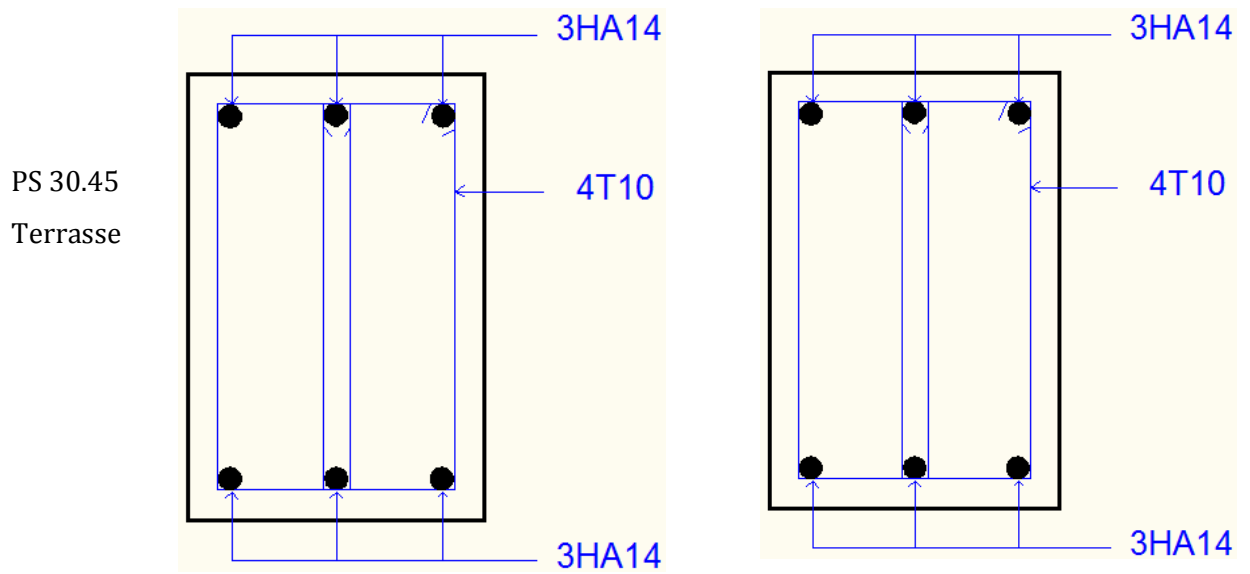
Section de ferrailage des poutres secondaire terrasse.
